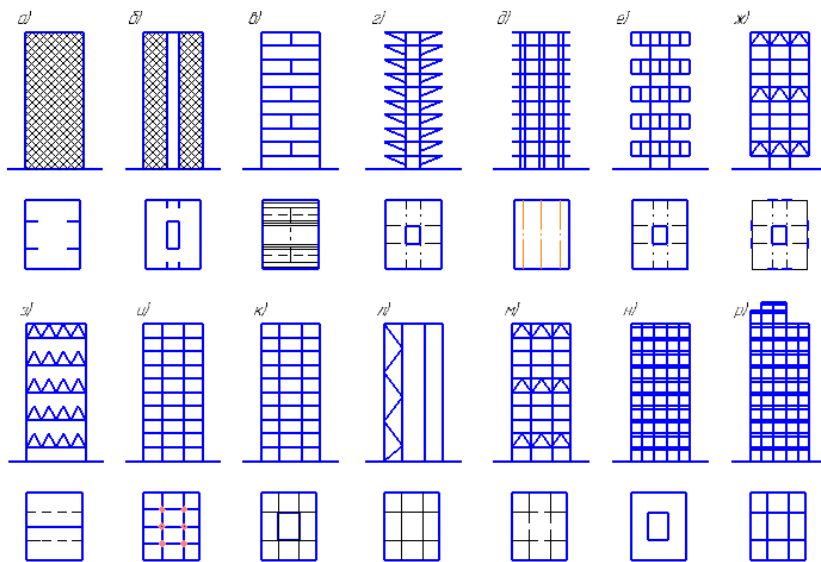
Конструктивные схемы высотных зданий (монолитных, сборных, сборно-монолитных): *а* – бескаркасная с параллельными несущими стенами; *б* – ствольная с несущими стенами; *в* – коробчатая; *г* – с консольными перекрытиями в уровне каждого этажа; *д* – каркасная с безбалочными плитами перекрытия; *е* – с консолями высотой на этаж в уровне каждого второго этажа; *ж* – с подвешенными этажами; *з* – с фермами высотой на этаж, расположенными в шахматном порядке; *и* – рамно-каркасная; *к* – каркасно-ствольная; *л* – каркасная с решетчатыми диафрагмами жесткости; *м* – каркасная с решетчатыми горизонтальными поясами и решетчатым стволом; *н* – коробчато-ствольная (труба в трубе); *п* – многосекционная коробчатая
